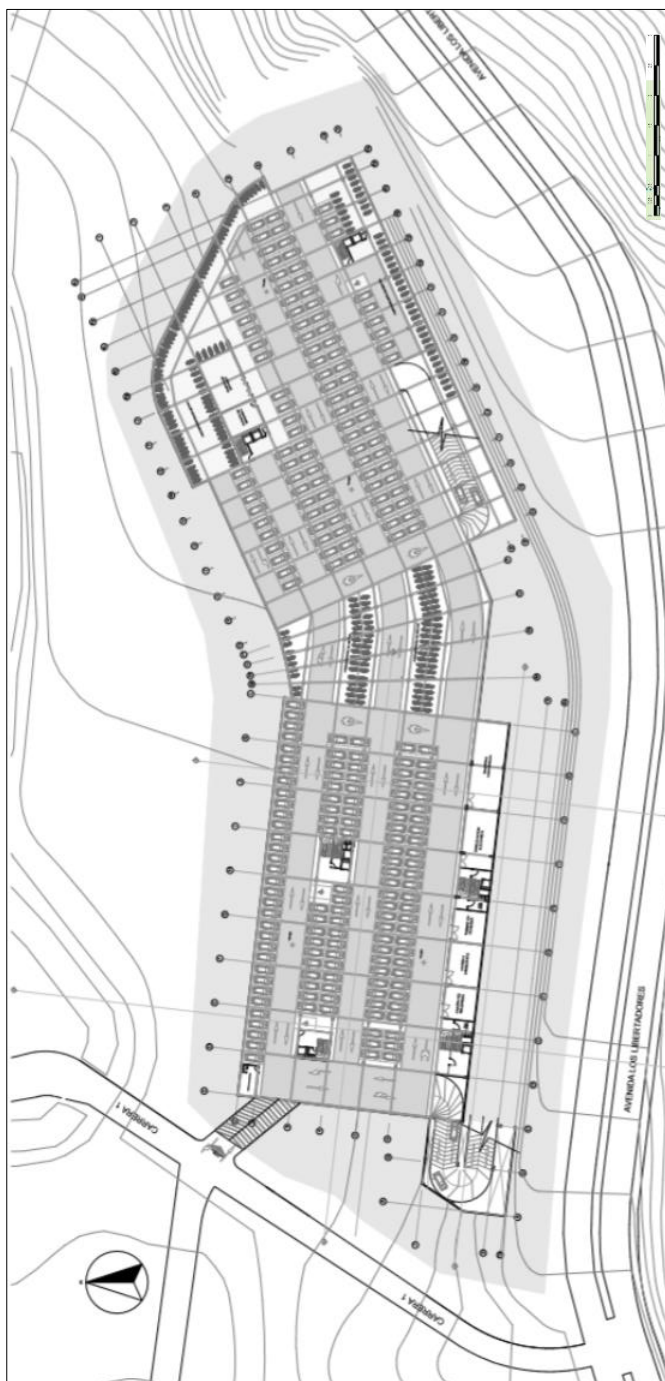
Planta arquitectónica nivel -3 parqueaderos
